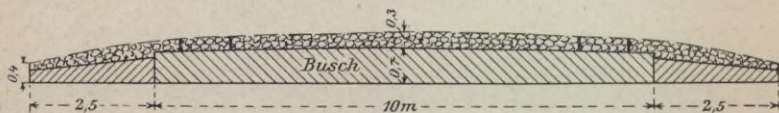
Querschnitt eines Sinkstückes mit Sinkstückkrampen bei der Düne von Helgoland.
